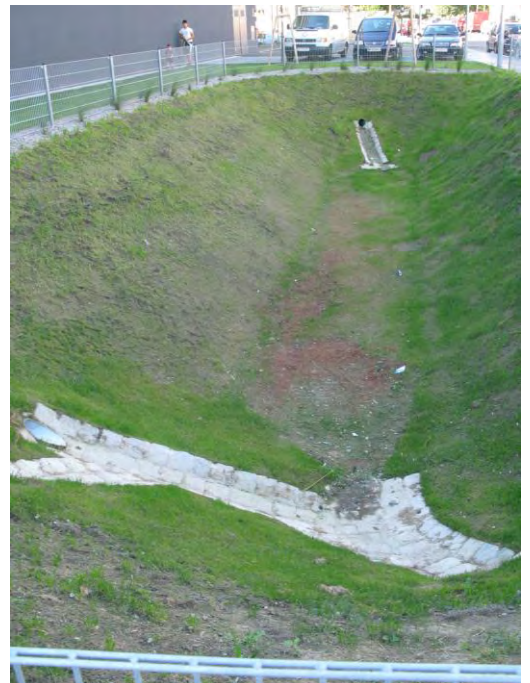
Grünmulden zur Versickerung der Dachflächenwässer (Foto: Büro Grimm)
